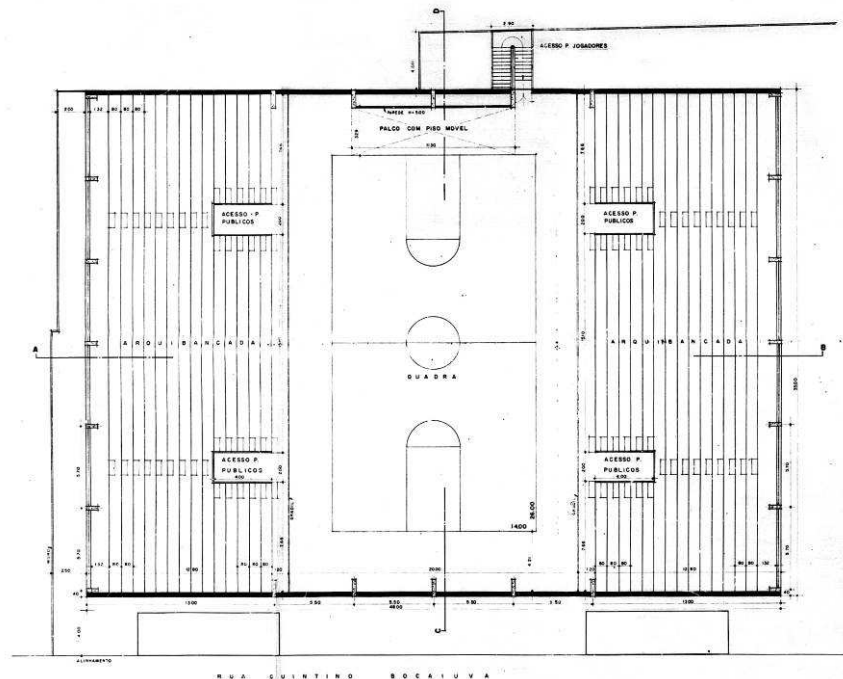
Planta baixa, segundo pavimento (Fonte: Arquivo Municipal de POA)
